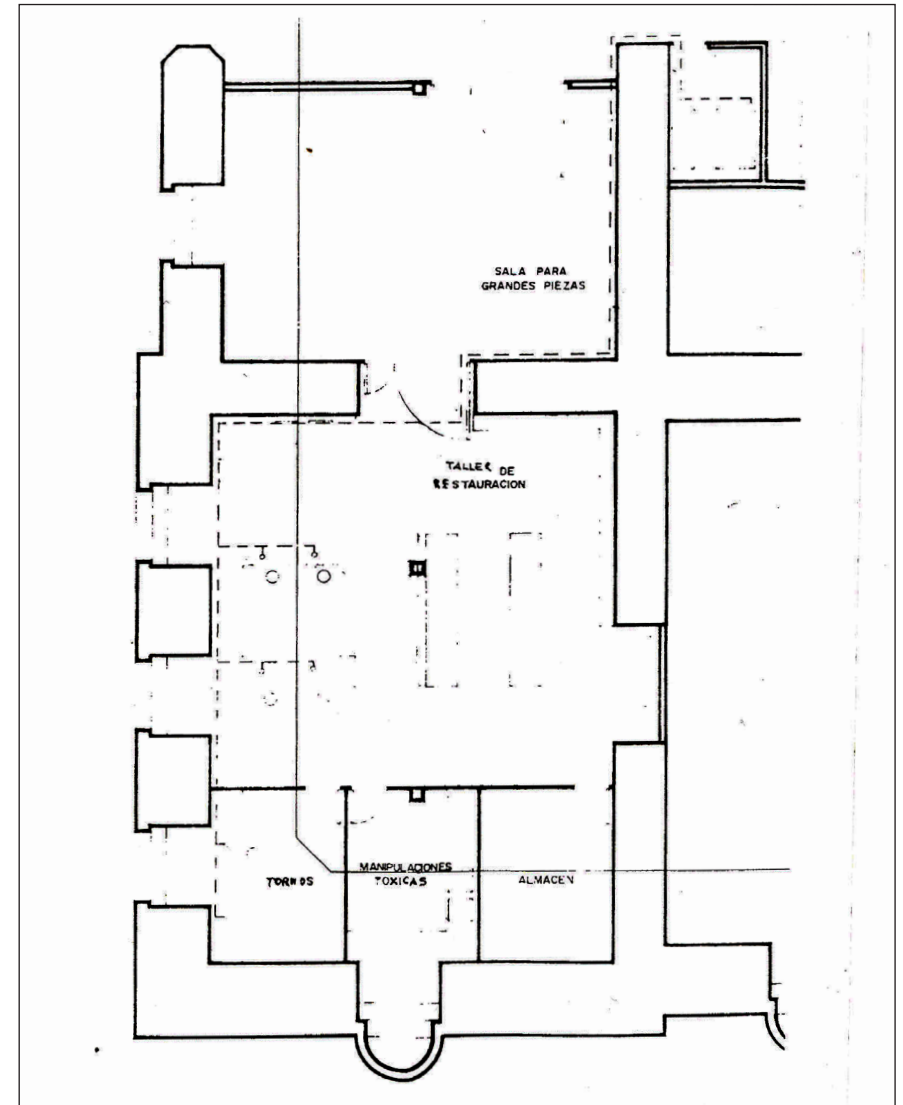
Plano del Laboratorio de Restauración en la 1.ª planta, antes de su remodelación definitiva, en 1991. Arquitecto D. Luis Moya, sección de los planos del Proyecto de 1975 (Archivo MAN).
